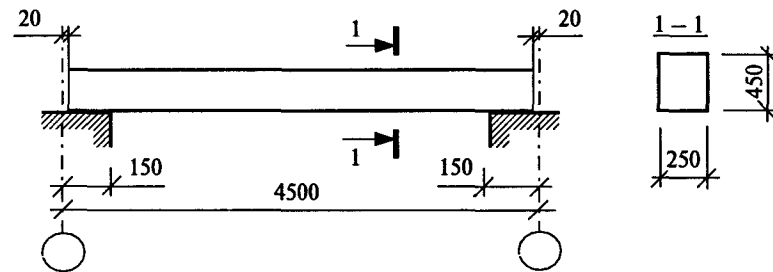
Опираие балки на стены — к задаче 7.10
